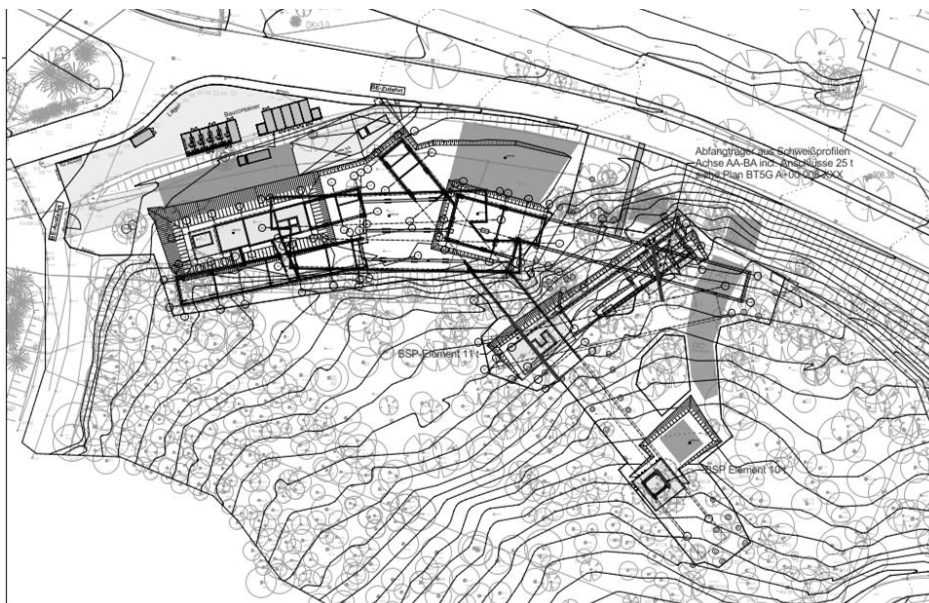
Baustelleneinrichtungsplan Bauherr, Quelle: Ausschreibungsunterlagen BH
